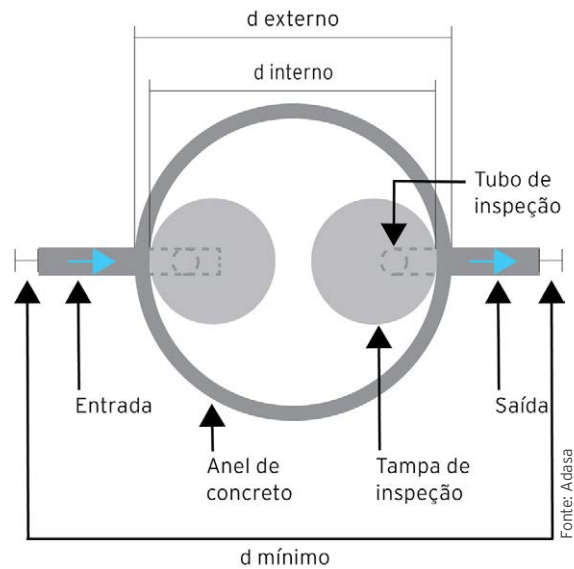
Poço de Infiltração com Preenchimento - Vista Superior.
